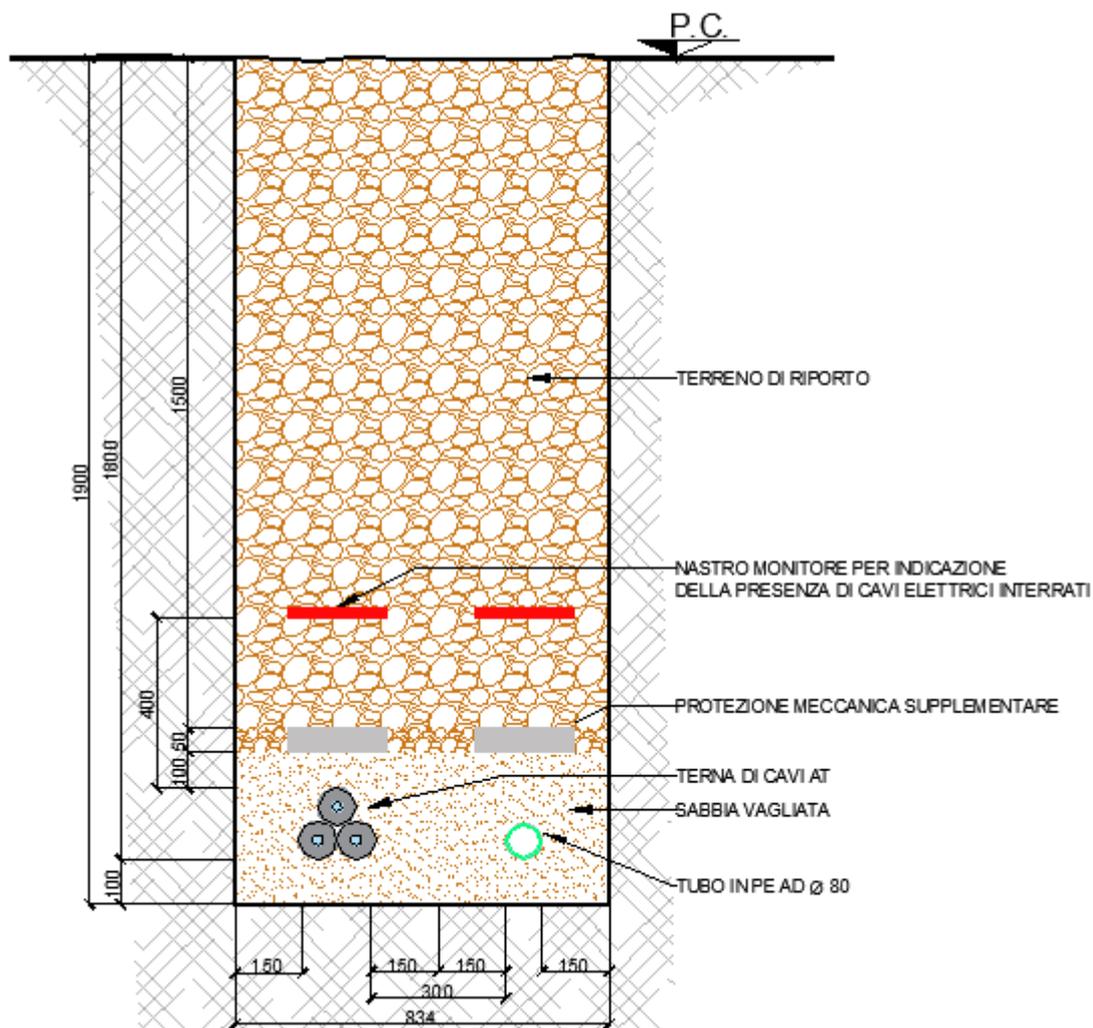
Sezione scavi tipo posa cavidotti AT
